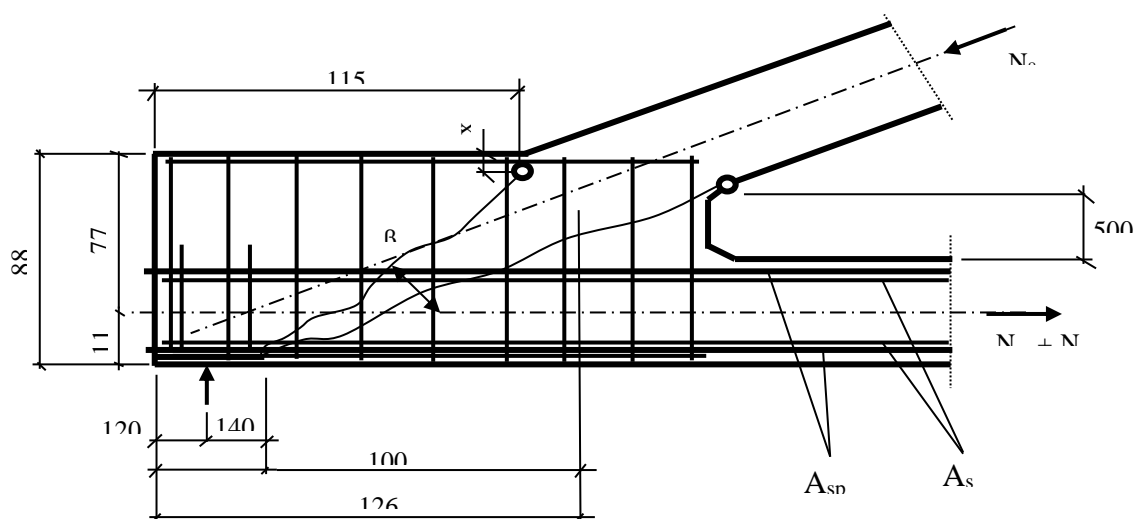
Розрахункова схема опорних вузлів ферми
